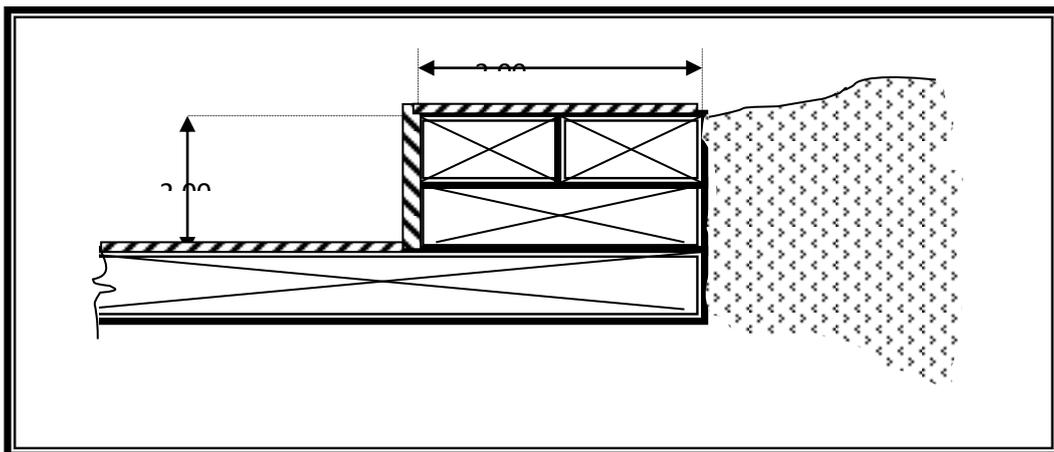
Croquis : coupe en travers des murs bajoyer (HCDS ; 2003)
